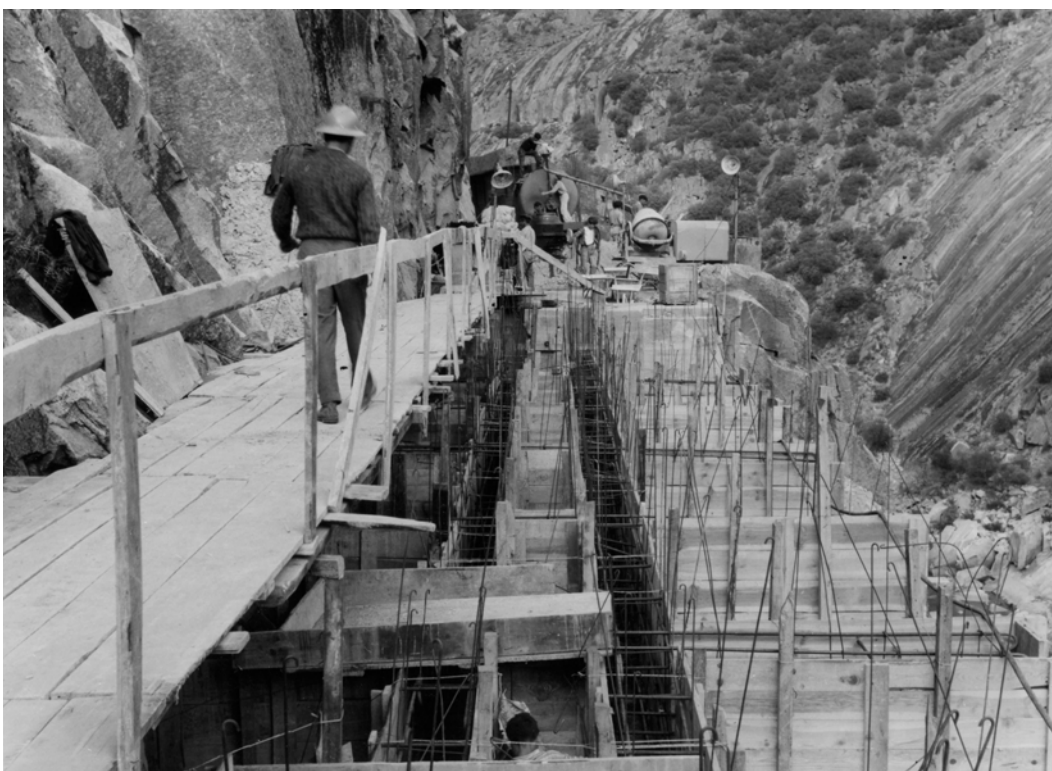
Viaduto das Fragas Más – cofragem e armaduras prontas a receber betão na estrutura celular no tramo do lado da Foz do Tua (fonte: REFER)
